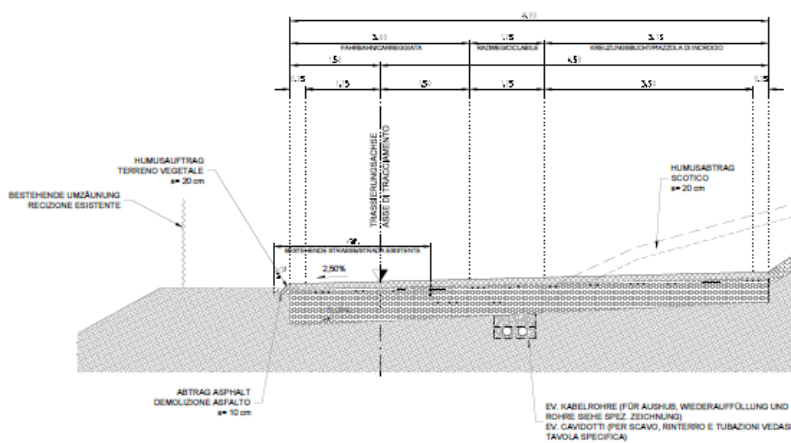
Regelquerschnitte Zufahrtstrasse Baustelle Genauen 2      Figura 3: Sezioni tipo strada di accesso al cantiere di Genauen 2
